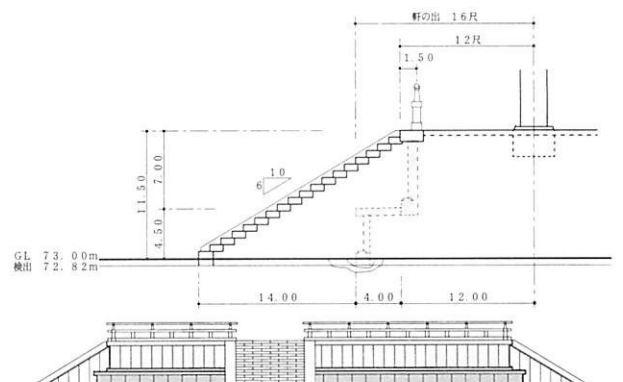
案③ 階段部分断面図(1:200)・東立面図(1:500)
